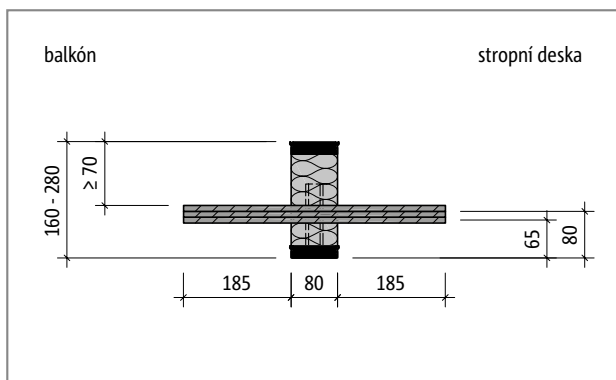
Schöck Isokorb® T typ HP-NN1: Půdorys prvku
